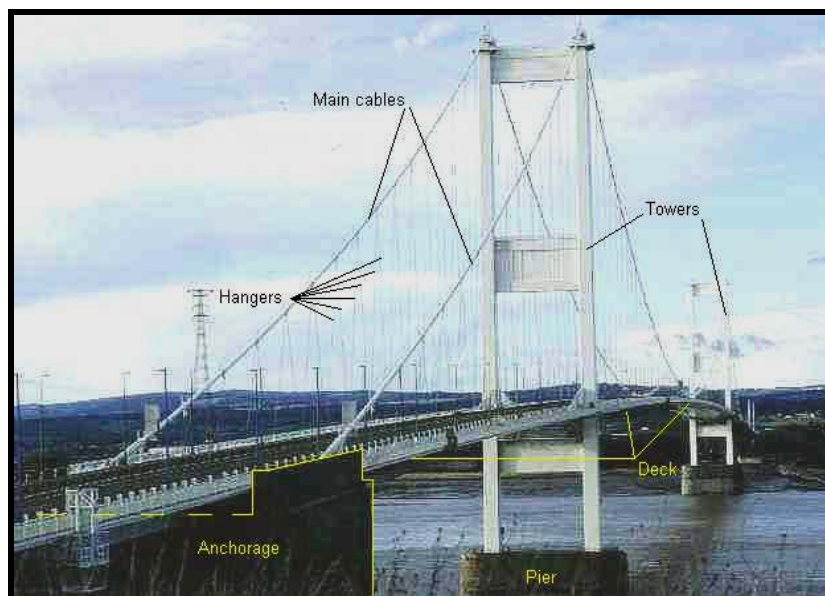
Elementos de uma Ponte Suspensa (fonte: www.brantacan.co.uk)
